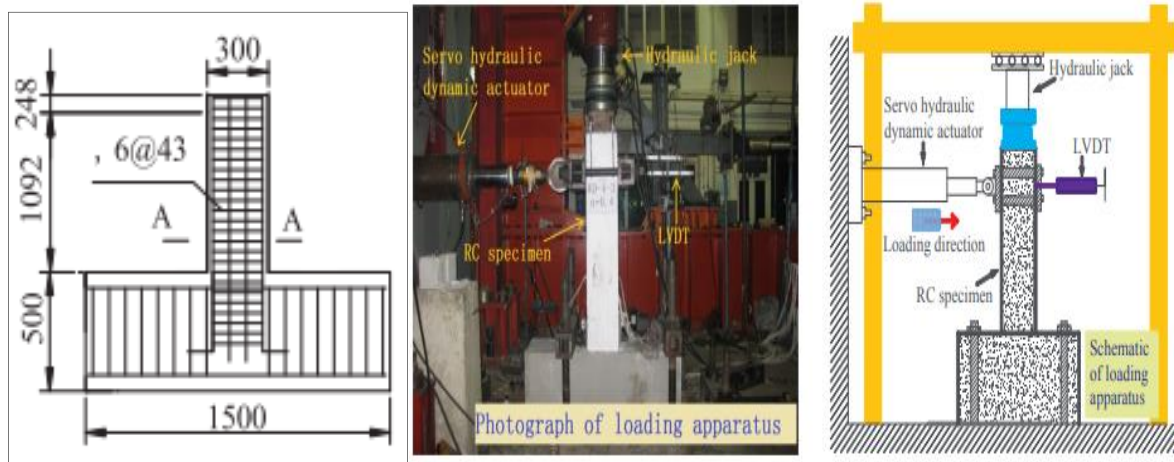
Détails structurel de la géométrie et du ferrailage du poteau Xie et al [65].
